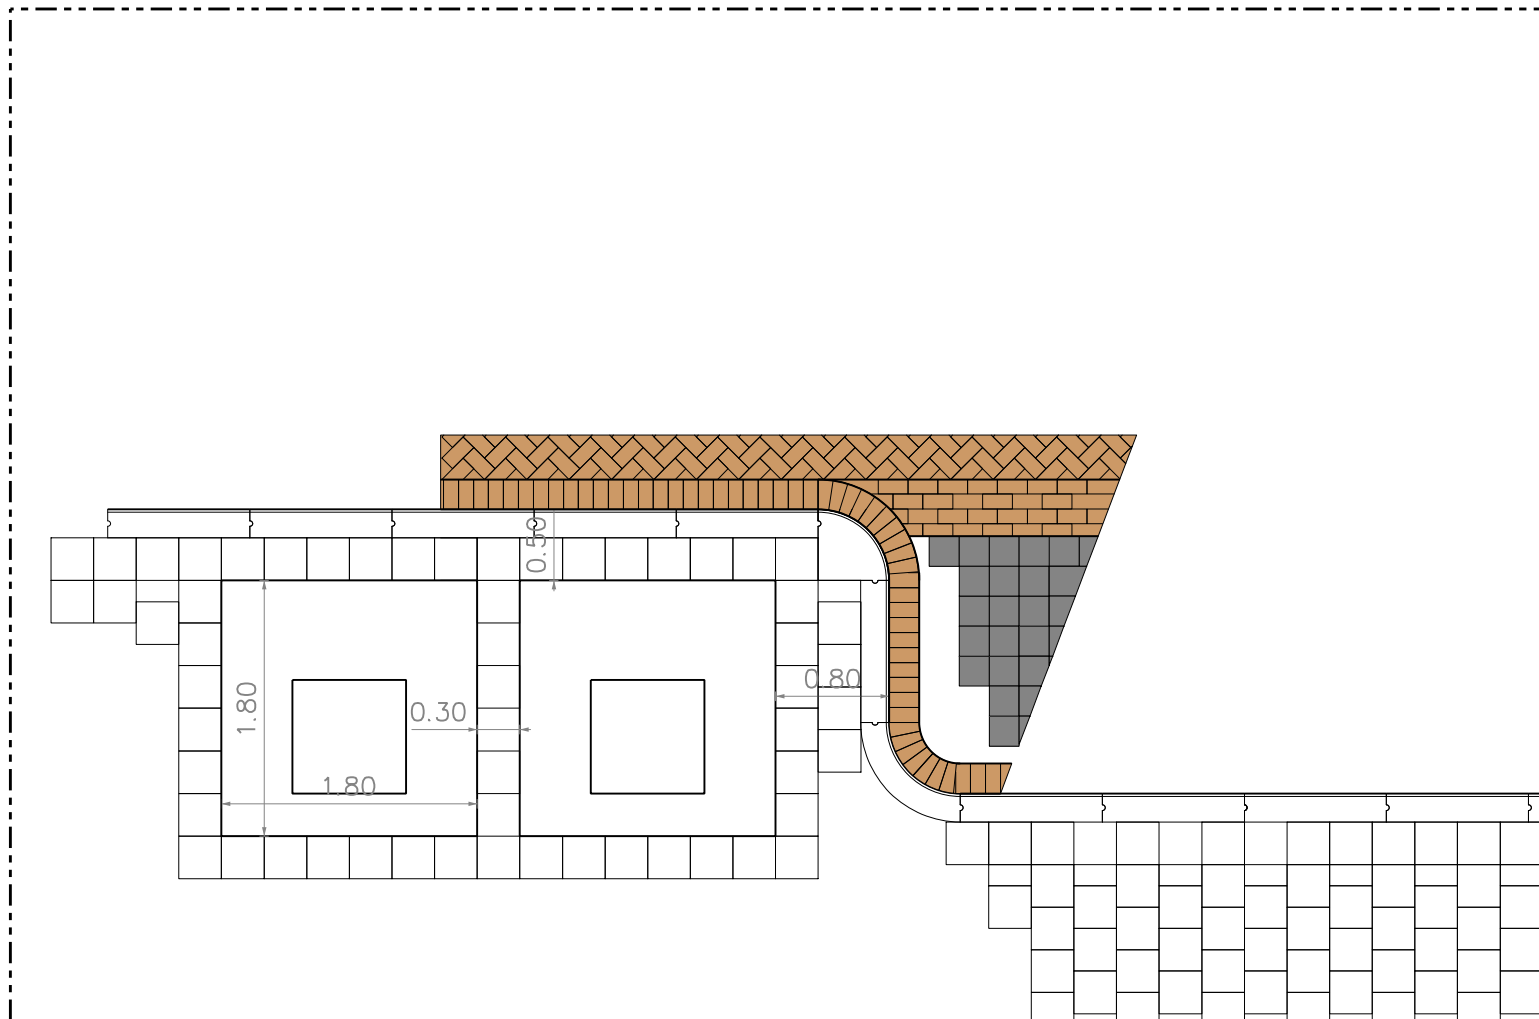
DETAIL UITMONDINGSSTUKKEN vk. 1330 (duiker)
